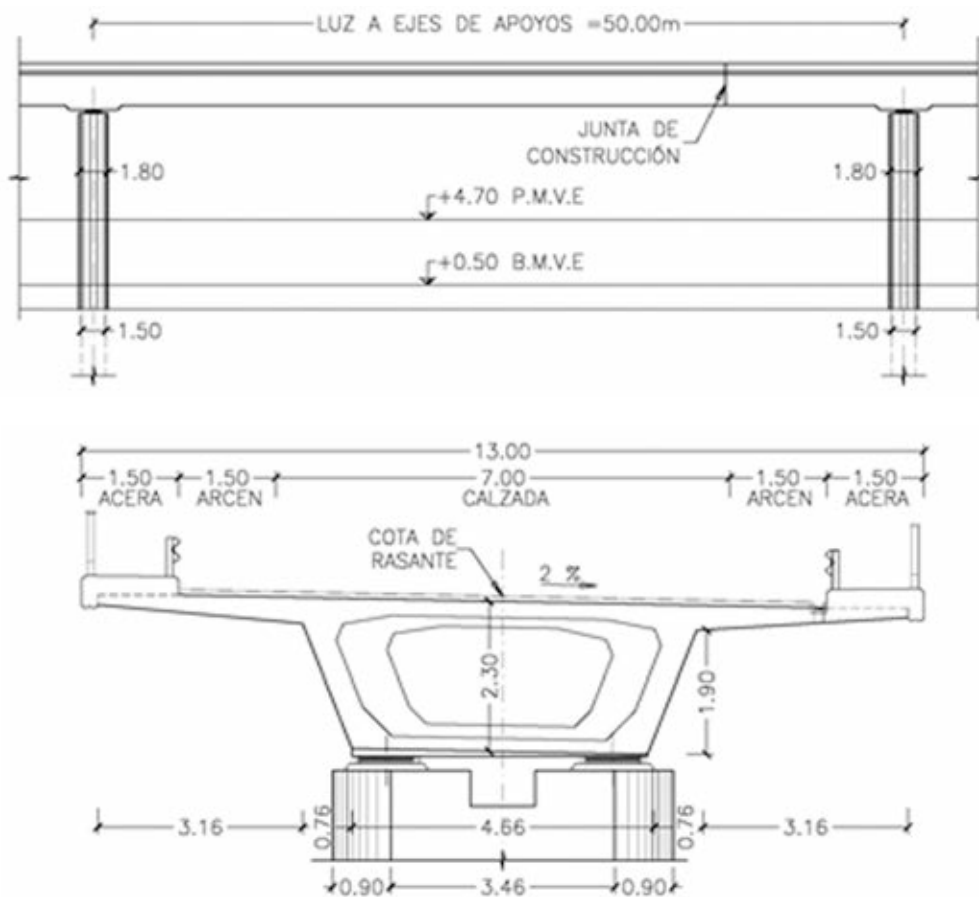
Esquema tipo del alzado del puente y de la sección transversal
